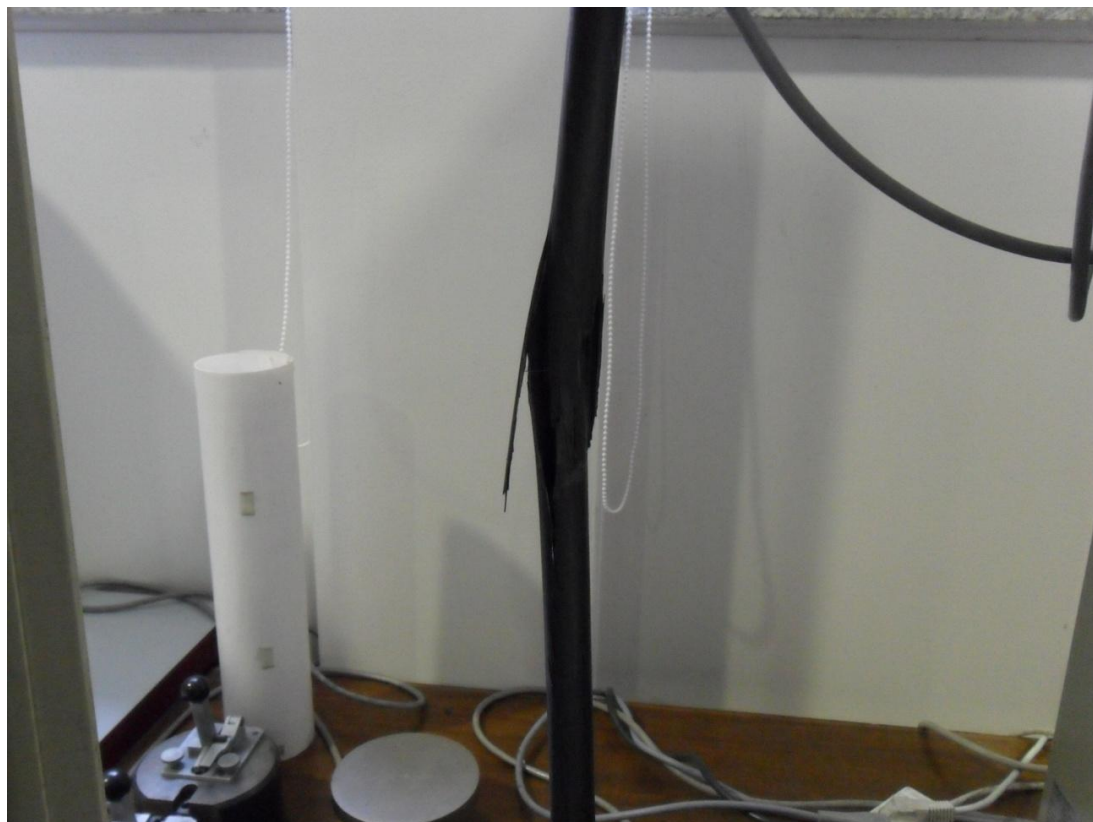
Pormenor da Fractura da Escora por Flambagem
